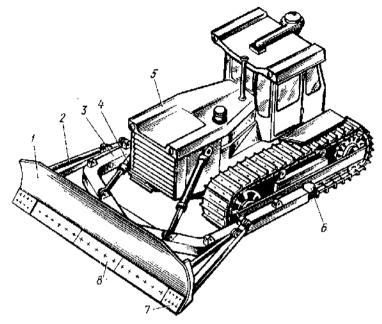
Гусеничный бульдозер с поворотным отвалом: 1 – отвал; 2 – толкатель с откосом; 3 – рама; 4 – гидроцилиндр; 5 – трактор; 6 – шарнир; 7, 8 – ножи
